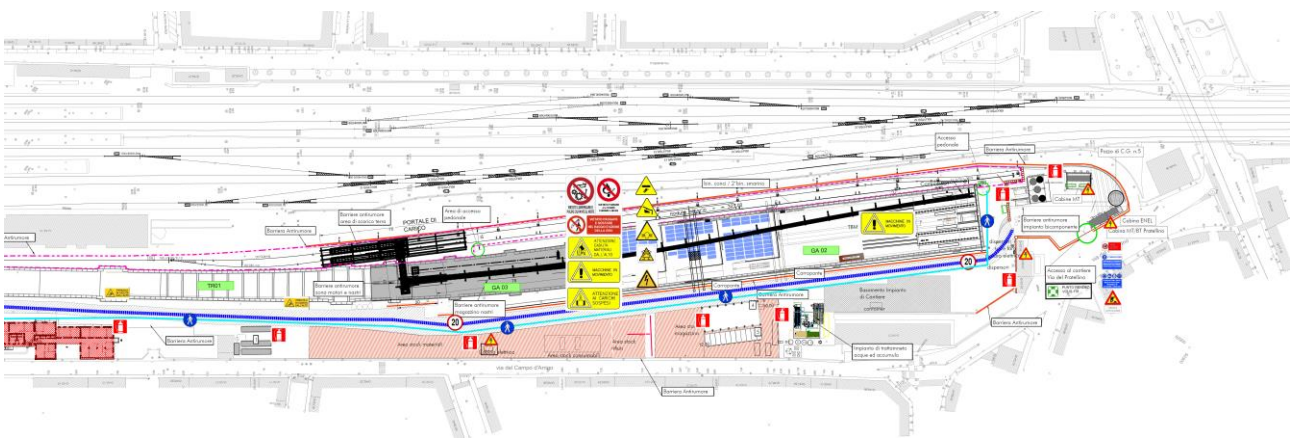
Stralcio planimetrico dell'area di cantiere di Campo di Marte
